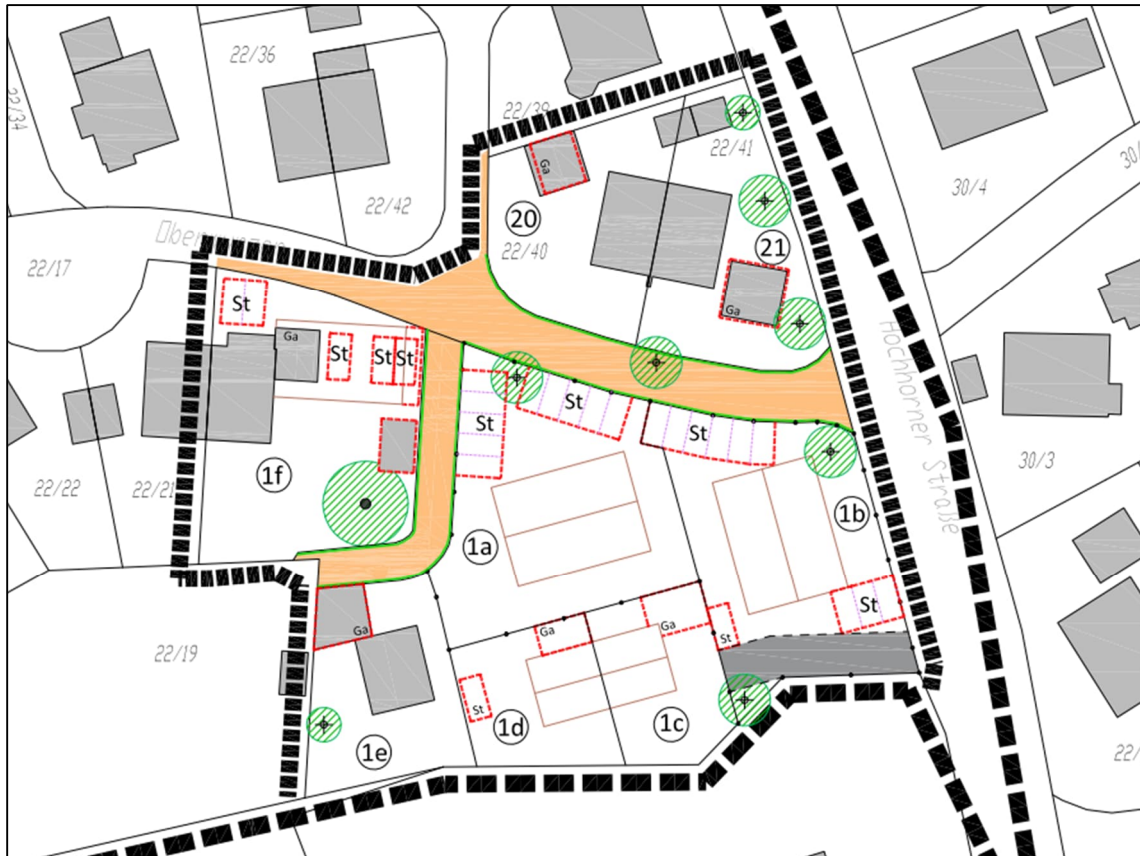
Lageplan mit Kennzeichnung aller geplanten Stellplätze /16/
